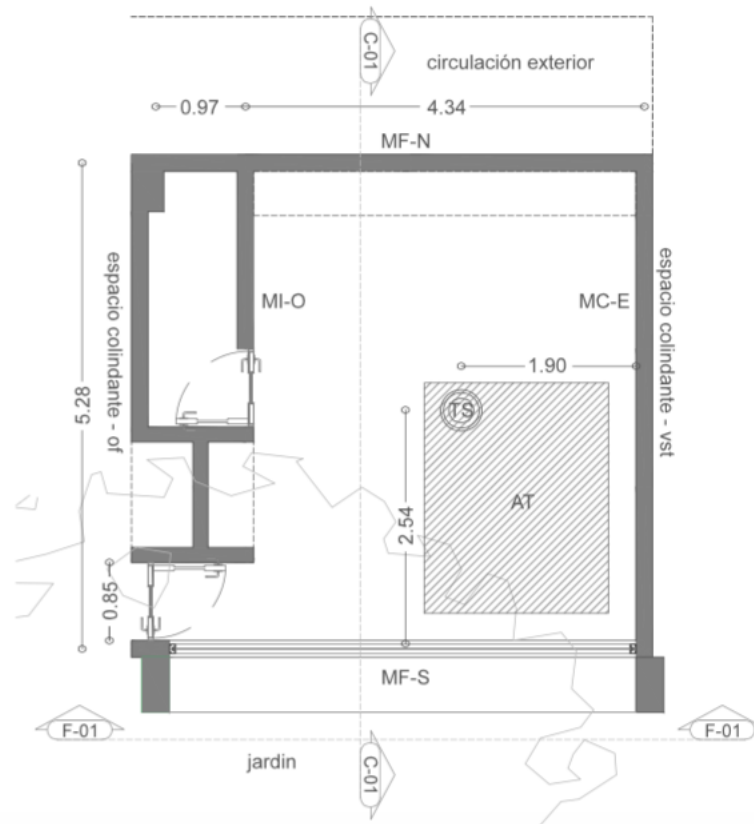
Planta de la oficina de la dirección del IER-UNAM, donde TS es la proyección de la ubicación del tubo solar en la cubierta, MF-S es muro fachada sur, MF-N es muro fachada norte, MC-E muro interior este, y MI-O es muro interior oeste, AT es el área de trabajo. C-01 indica proyección de Corte y F-01 proyección de fachada. Las cotas están en metros.
